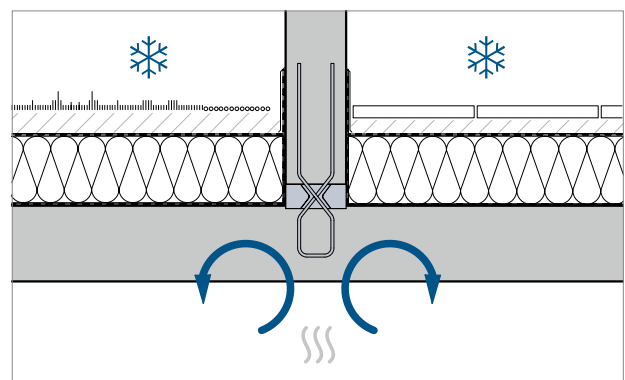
Pos ④: Wärmefluss bei Dachaufbau mit Schöck Scconnex® Typ W
